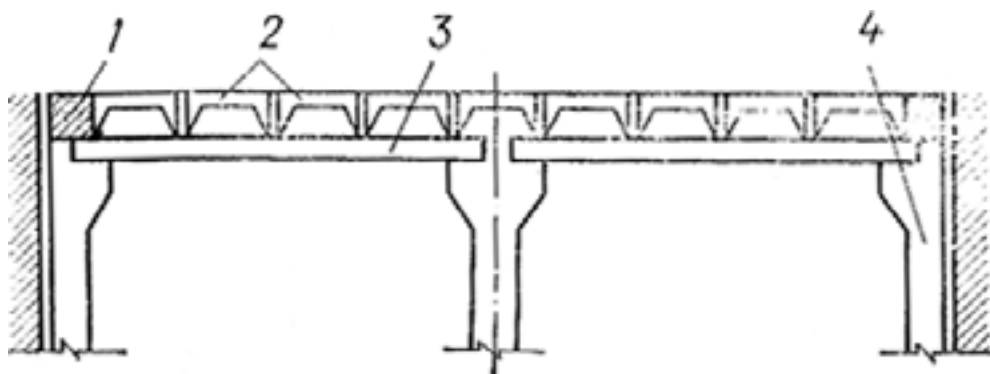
Устройство монолитного ригеля в сборном перекрытии: 1 – монолитный ригель; 2 – плиты; 3 – сборный ригель; 4 – колонна
